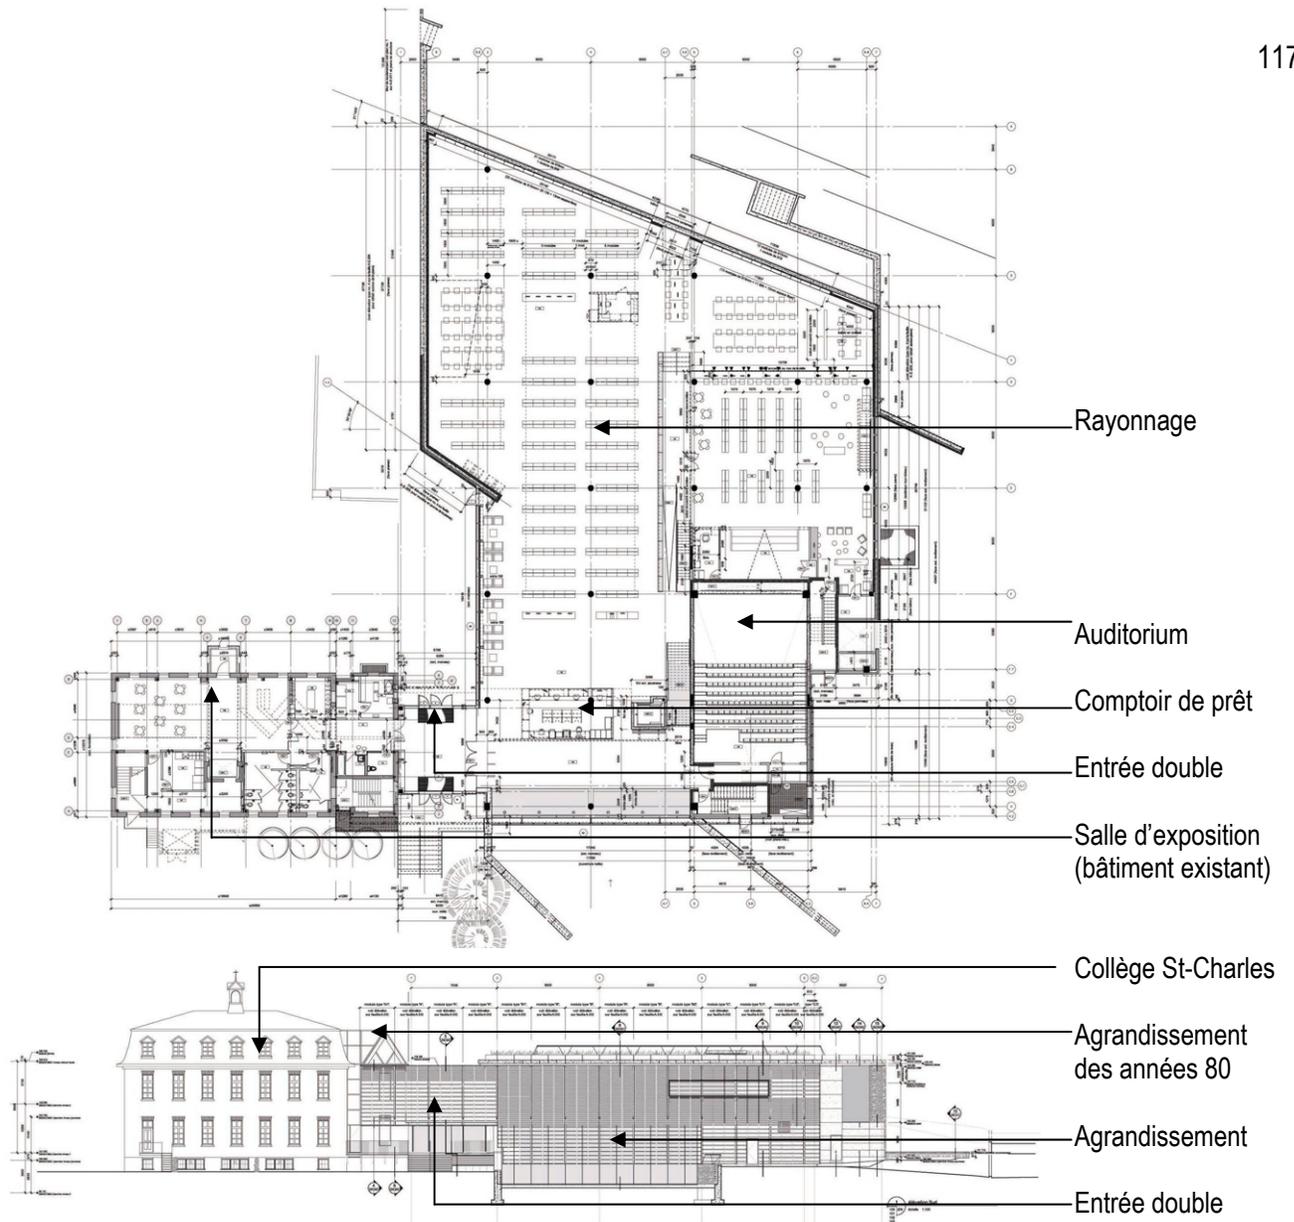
(A) Plan du rez-de-chaussée et (B) élévation sud-est (Source: Croft Pelletier Architectes)
